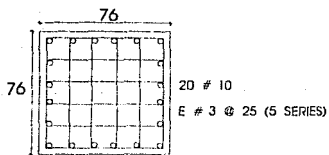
SECCION DE LAS COLUMNAS DEL SEGUNDO NIVEL A LA AZOTEA
